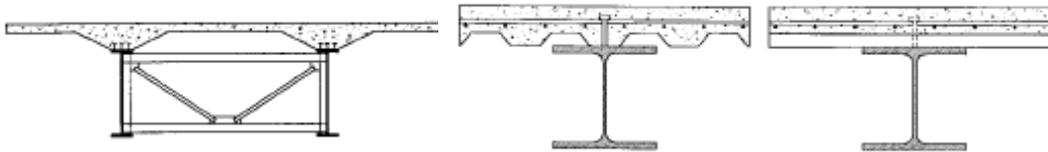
(a) Pontes mistas. (b) e (c) Laje steel deck em sistema de piso
